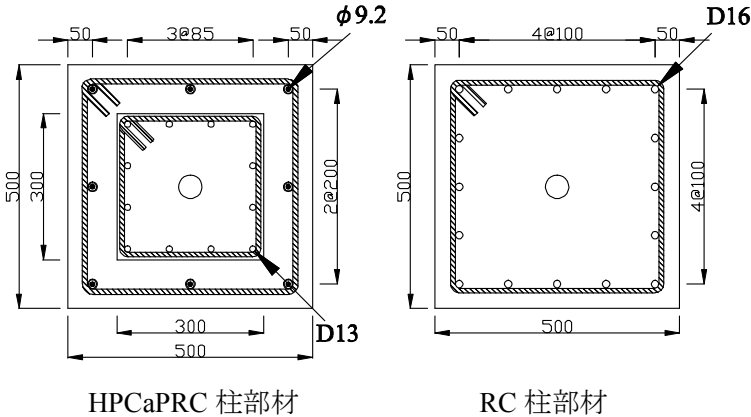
HPCaPRC 断面、RC 断面図（単位：mm）
